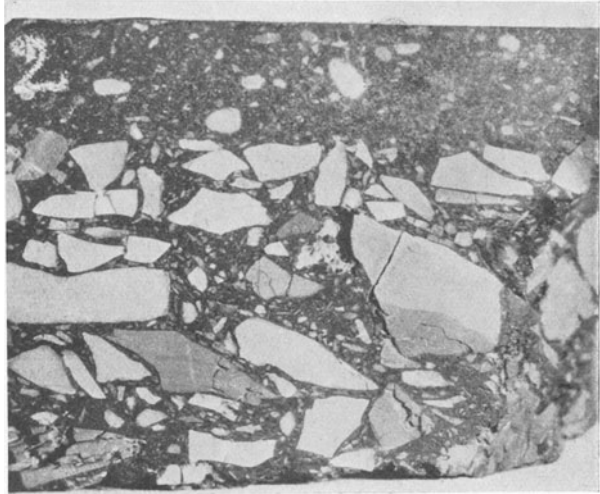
und 177. Angeschliffene Schnitte von Asphaltfeinbeton auf Binderlage (etwa nat. Größe).
